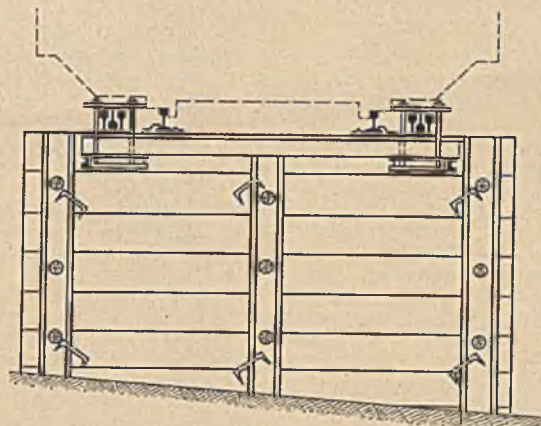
Querschnitt durch die obere Gleisabfangung mit Baugrube zur Herstellung der provisorischen Fundamente für die Gleisbrücken.
